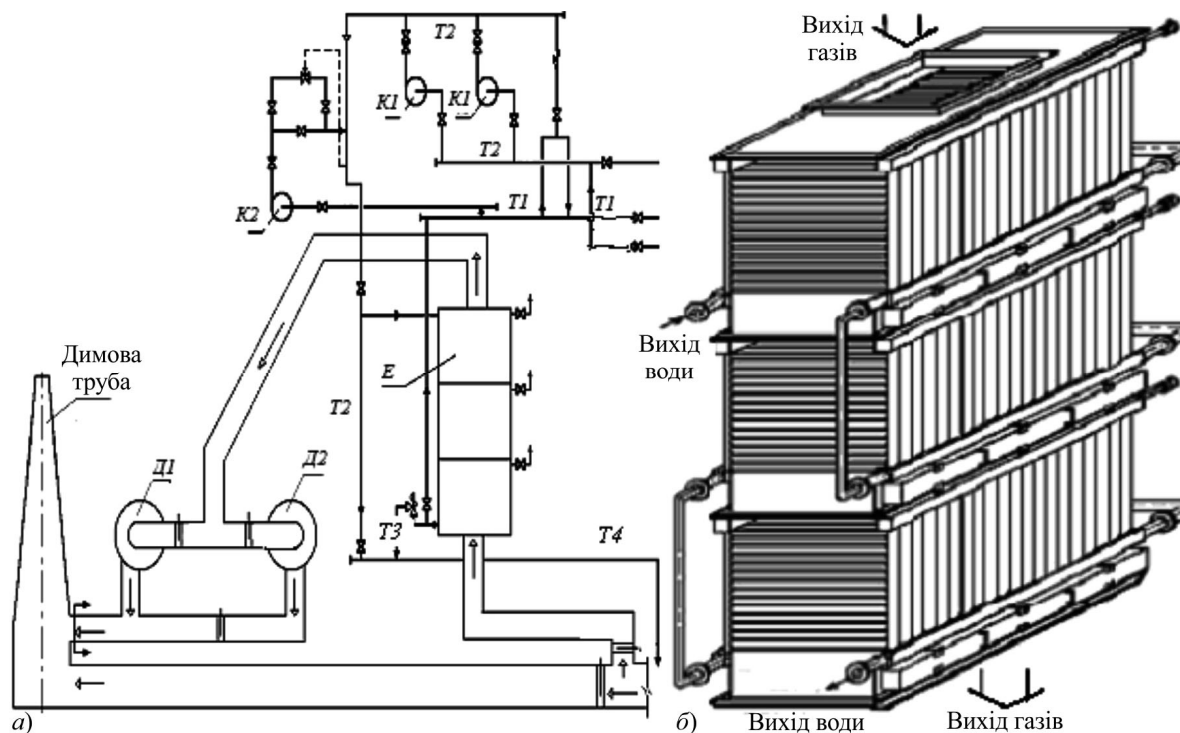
Схема теплоутилізаційної установки (а) з поверхневим водогрійним теплоутилізатором (б), призначеним для нагрівання води системи опалення: Е – теплоутилізатор; К – насоси; Т – трубопроводи теплової мережі; Т3 – трубопровід підживлювальний; Т4 – трубопровід для спорожнення теплоутилізатора; ∇ – вентиль, засувка; \rightarrow – видалення повітря; \rightarrow – напрямки потоків димових газів і води; ∇ – запобіжний і зворотний клапани
